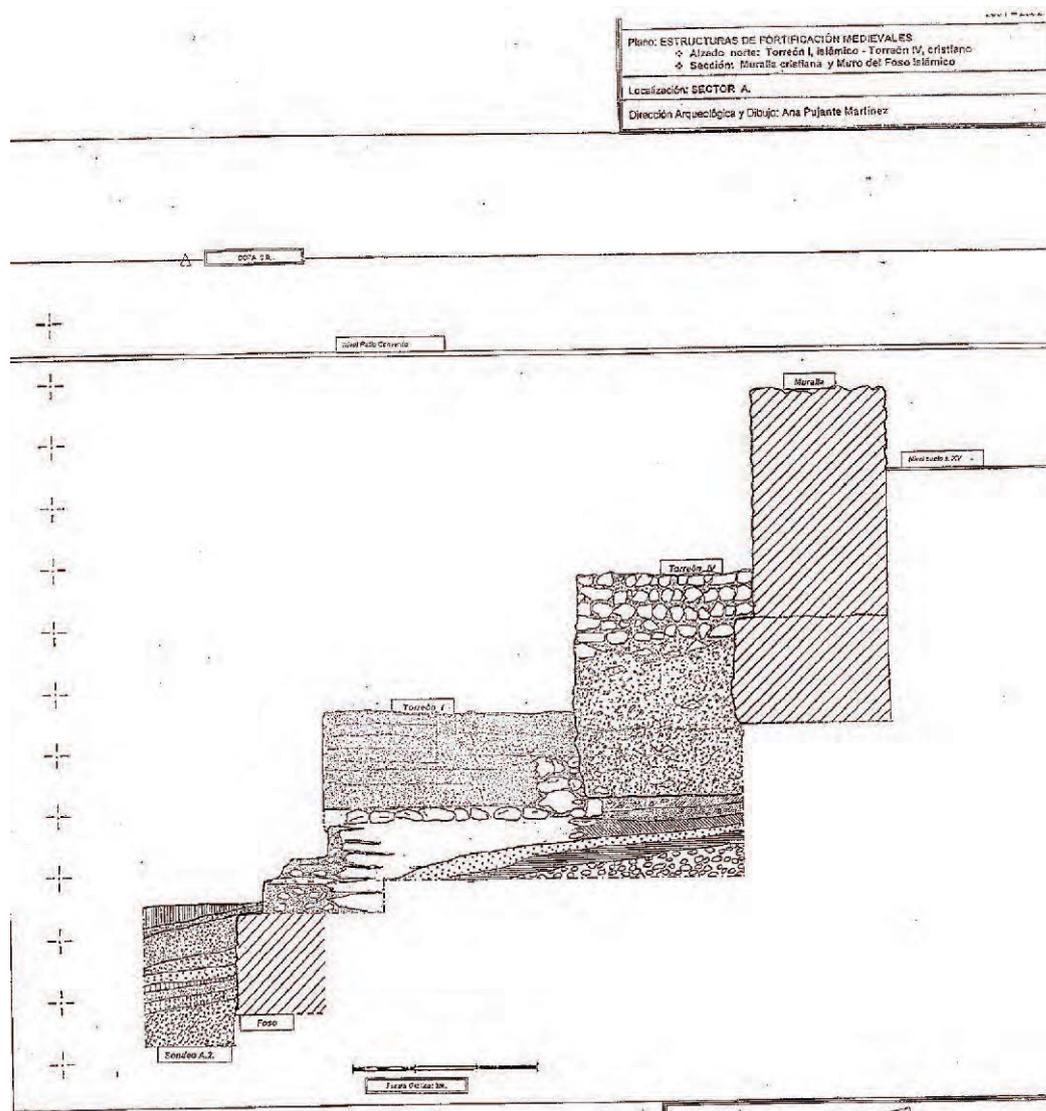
Sección estructuras de fortificación, adaptadas a la pendiente
